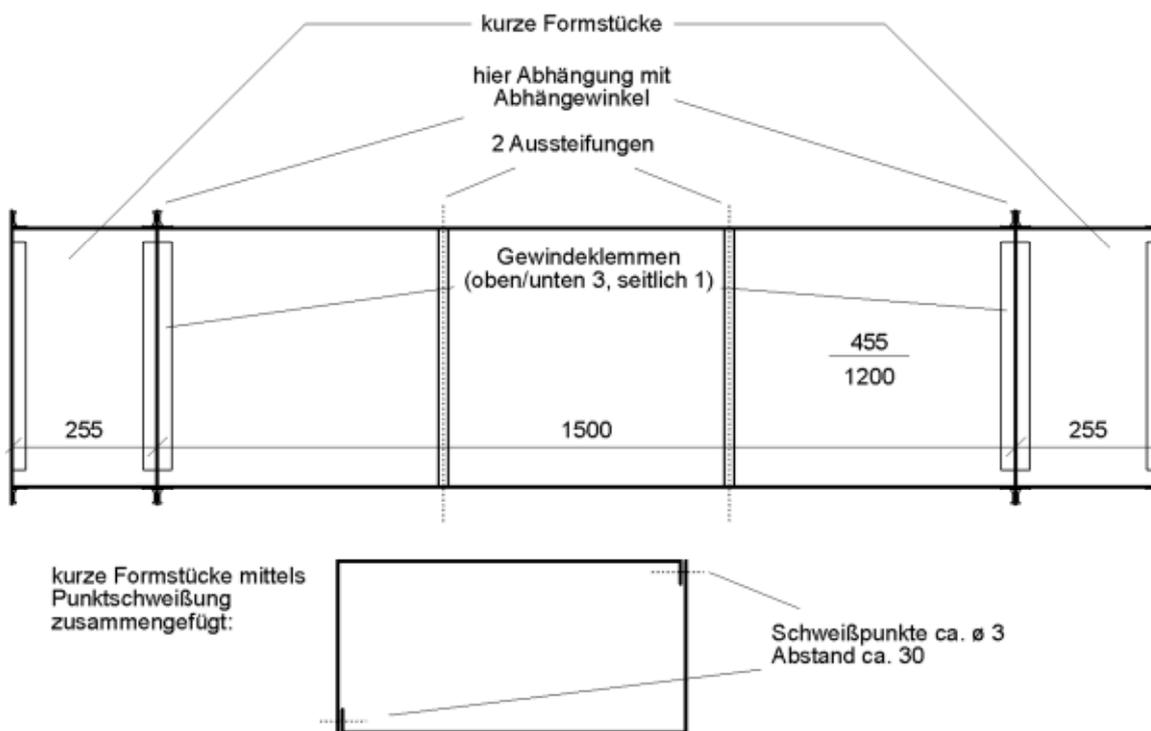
Probekörper 2: Kanalstück, mit Abhängewinkeln abgehängt und mit Gewichten beschwert
